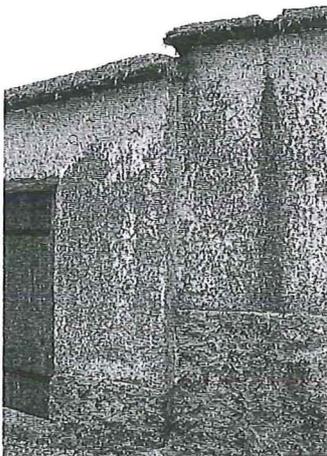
Estado de erosión de la fachada tras desprenderse una gárgola del alero.
